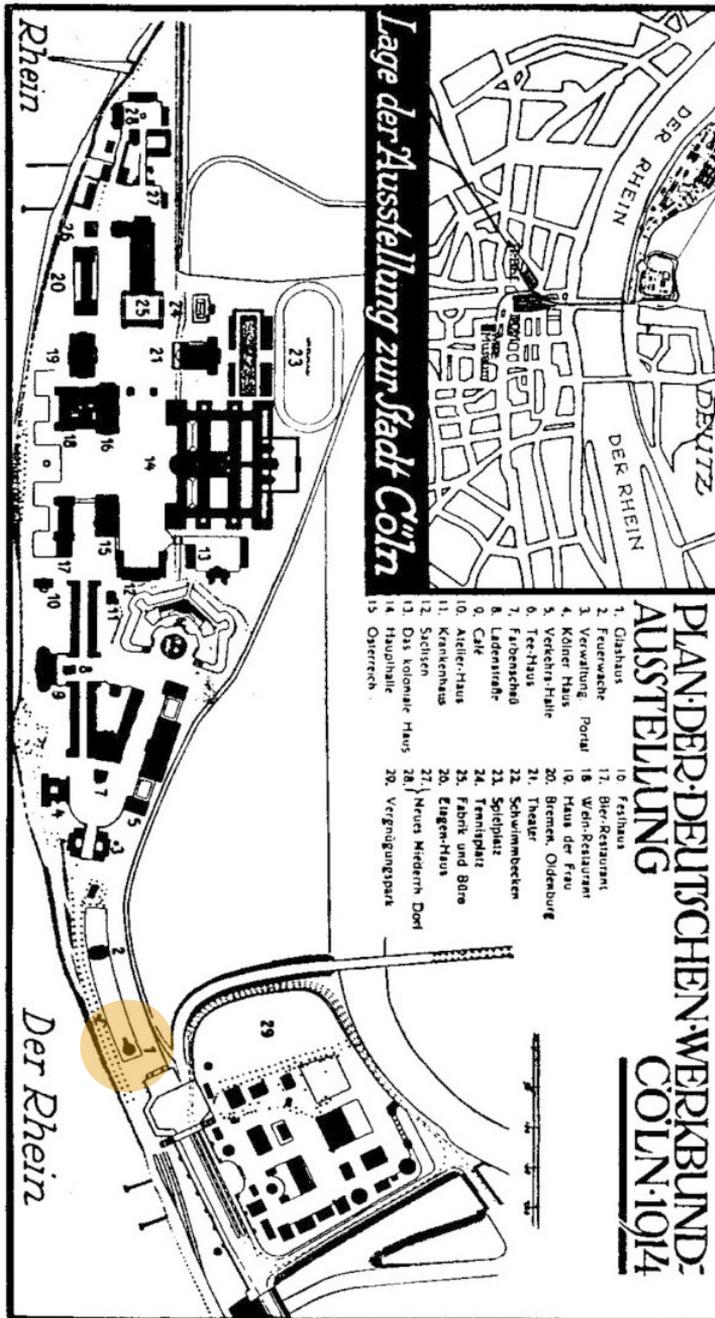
Lageplan Werkbundaussstellung 1914, Köln
